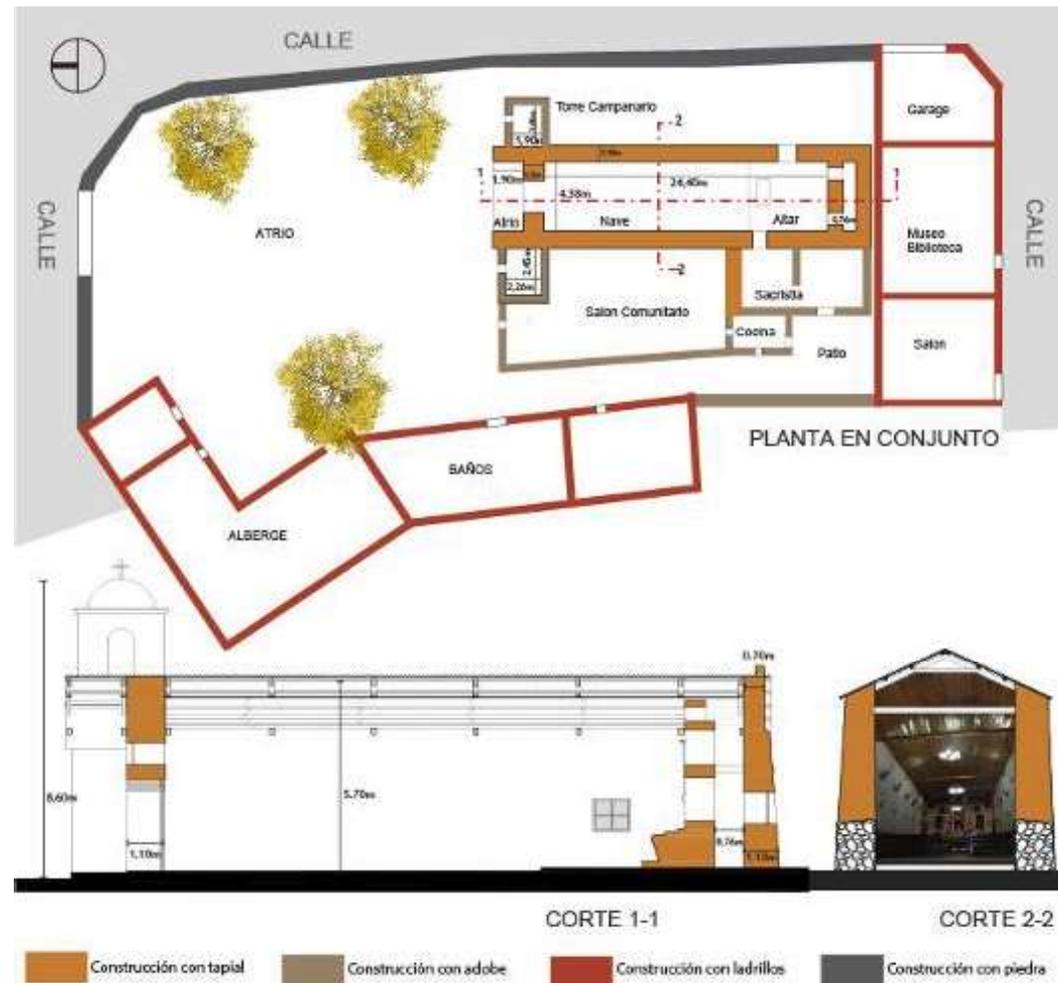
Planimetría del conjunto de la Iglesia de Nazareno (elaboración Dorado y Veliz)
